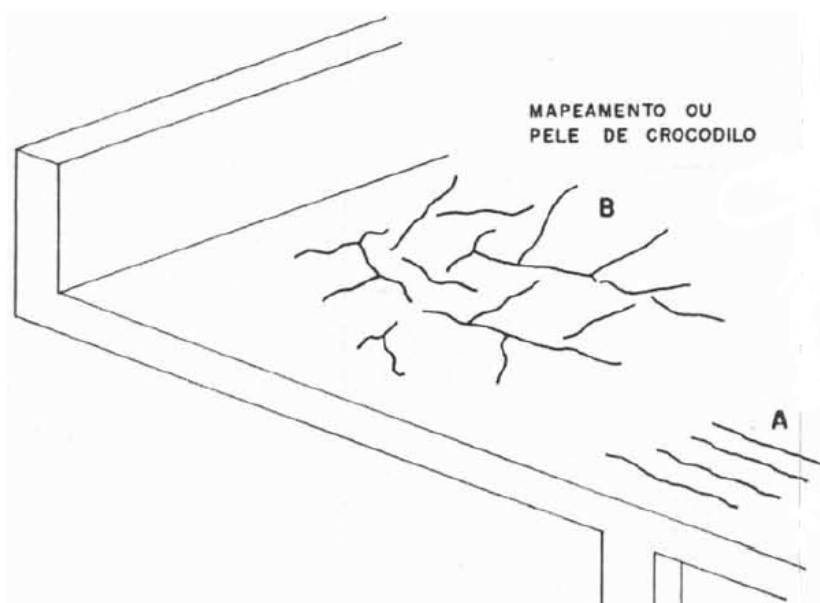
Fissuração por dessecação superficial em lajes contínuas.
